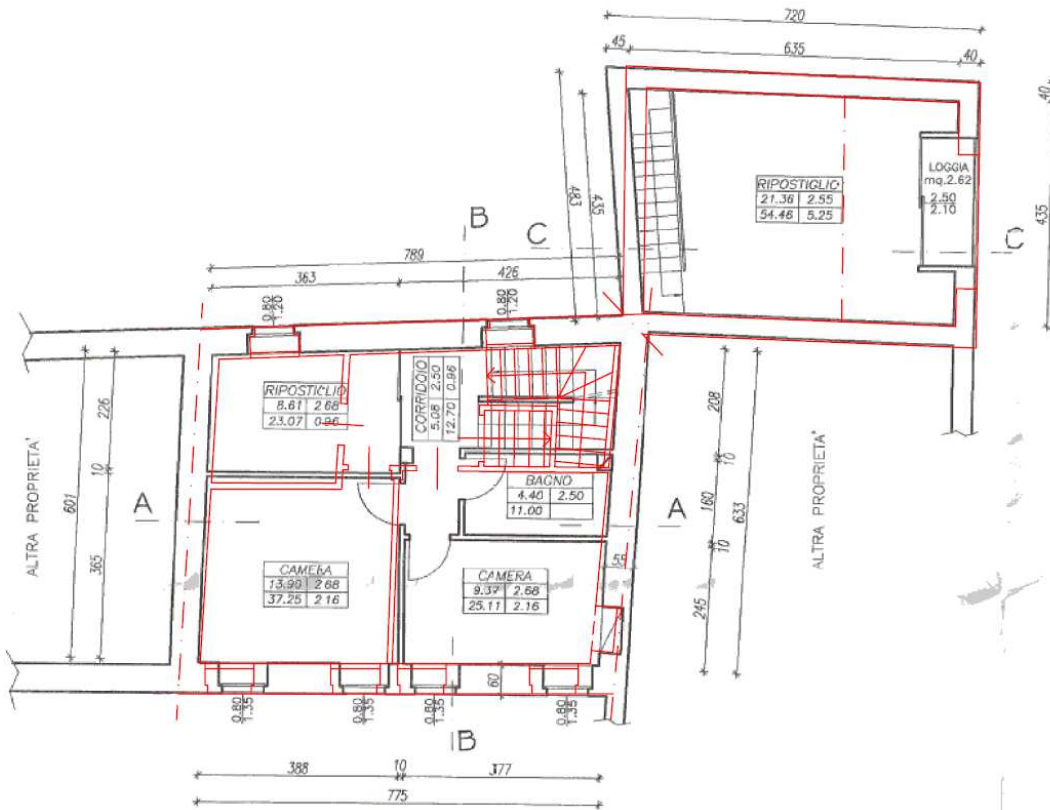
Comparazione stato attuale – stato approvato – piano primo.
